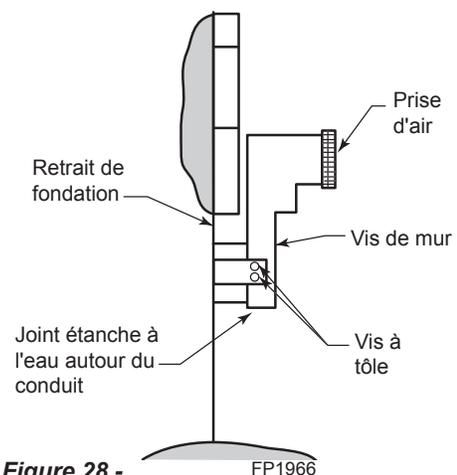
Installation du nécessaire de prise d'air, fondation en retrait
